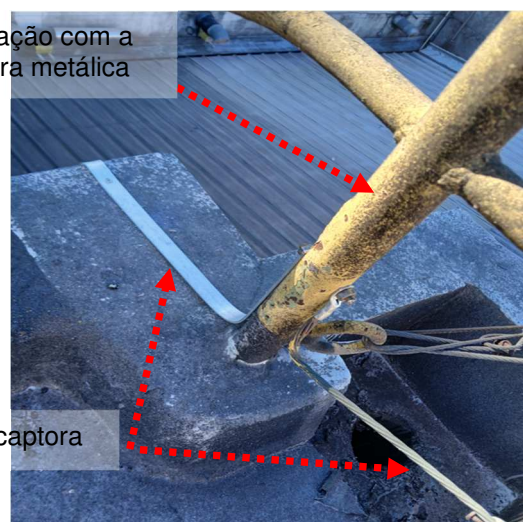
e 61: Malha captora construída em perfil de alumínio seção #70mm².
